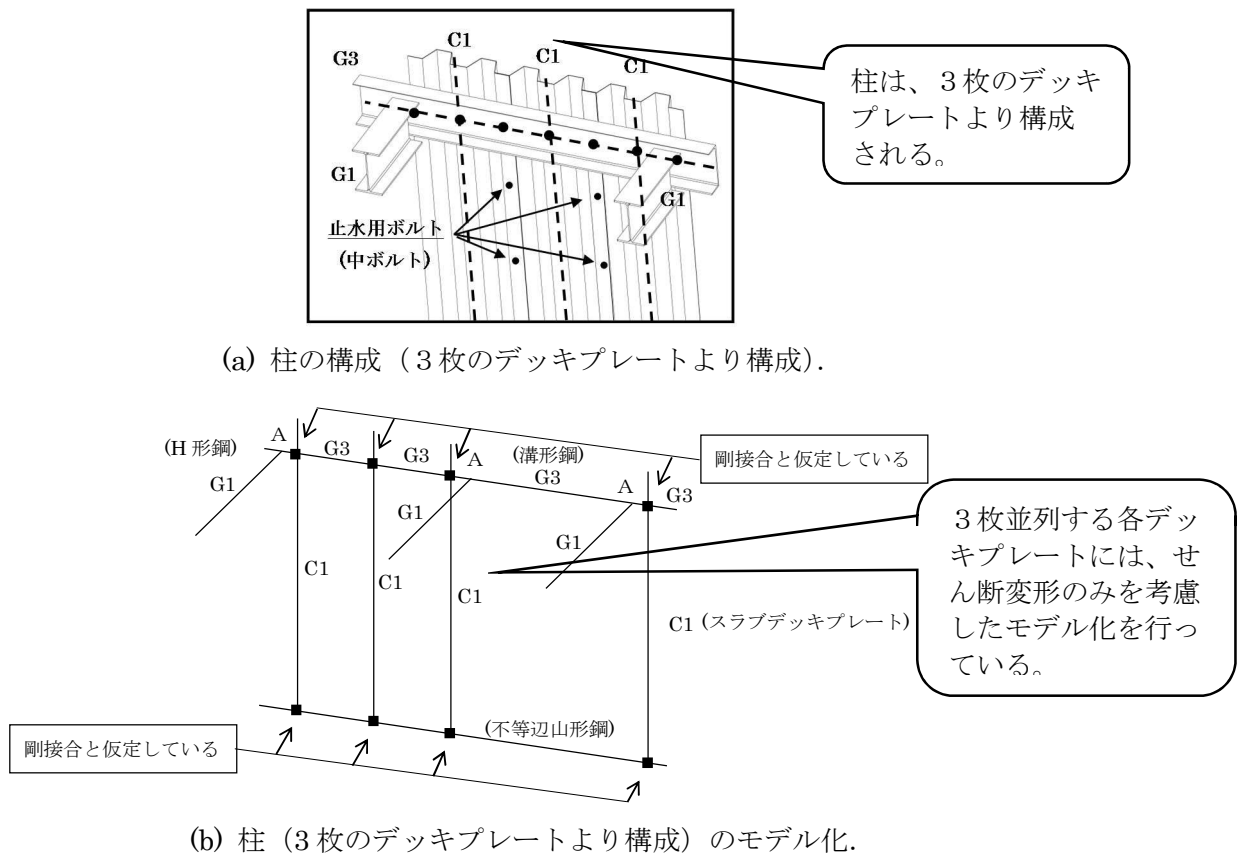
3枚のデッキプレートより構成される柱のモデル化。
